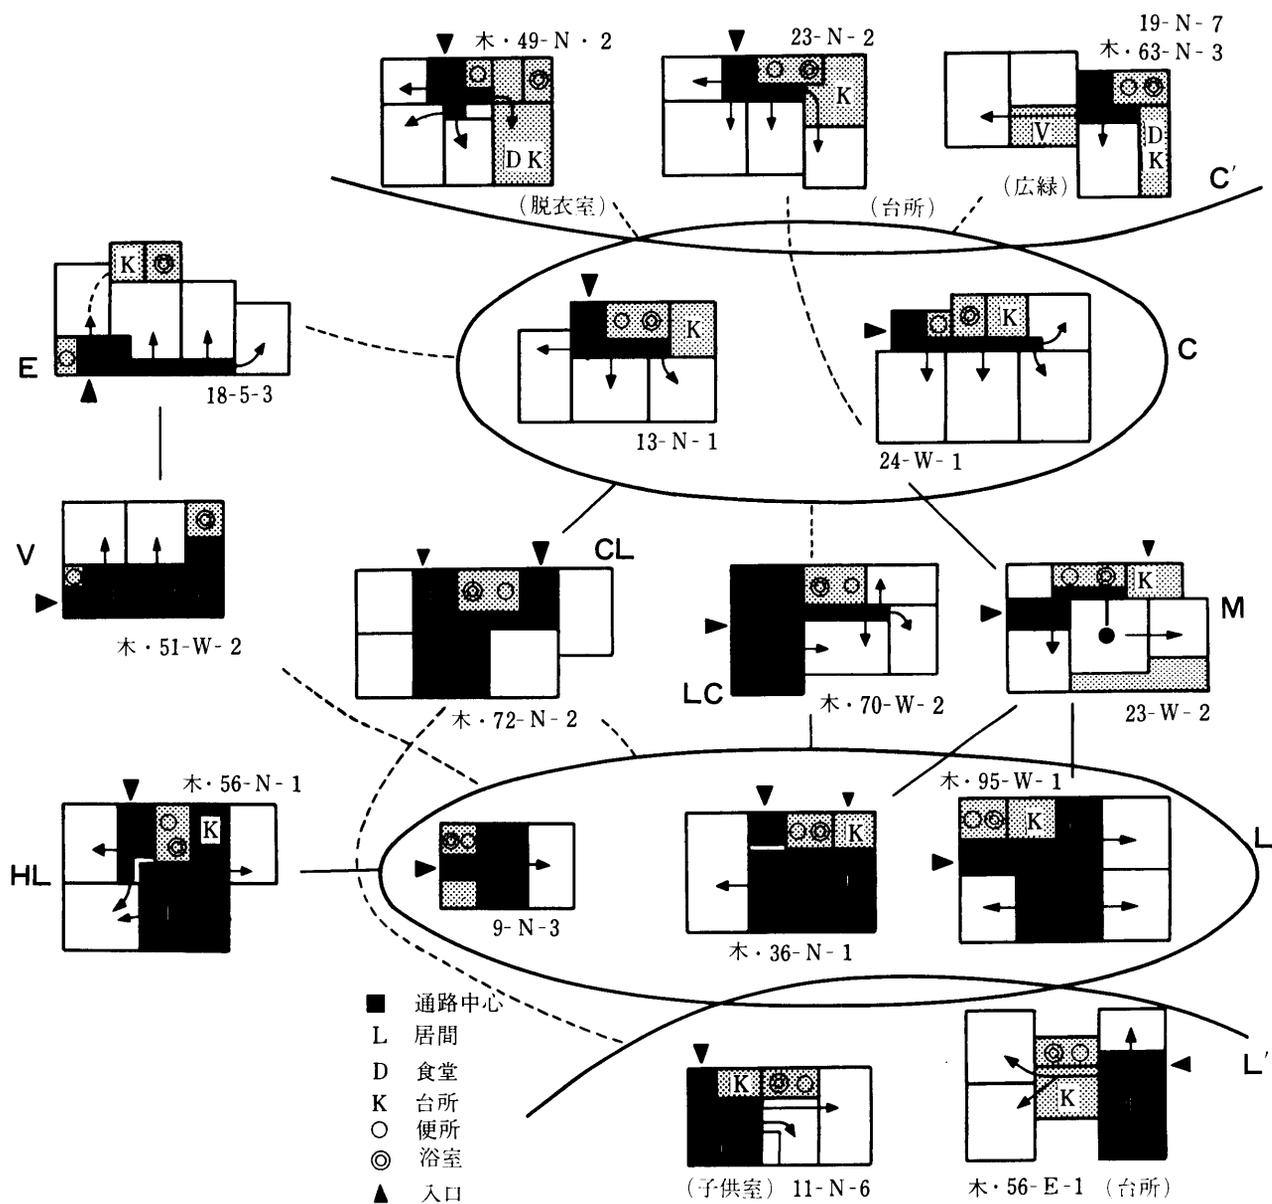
西山卯三による「公庫標準住宅の平面タイプ図」
